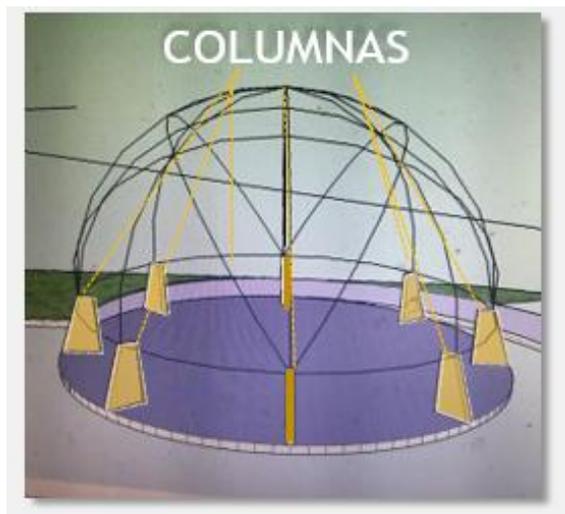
Proceso de levantamiento de Anteproyecto 3D. Fuente Elaboración propia
